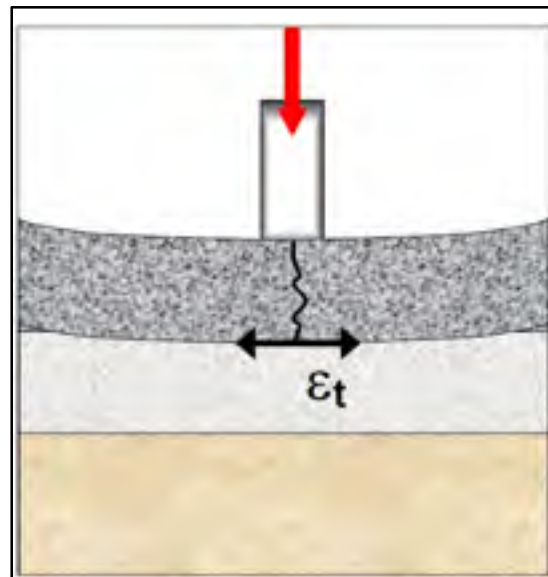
Mécanisme de fissuration par fatigue dans les chaussées bitumineuses (Priest & Timm, 2006)
